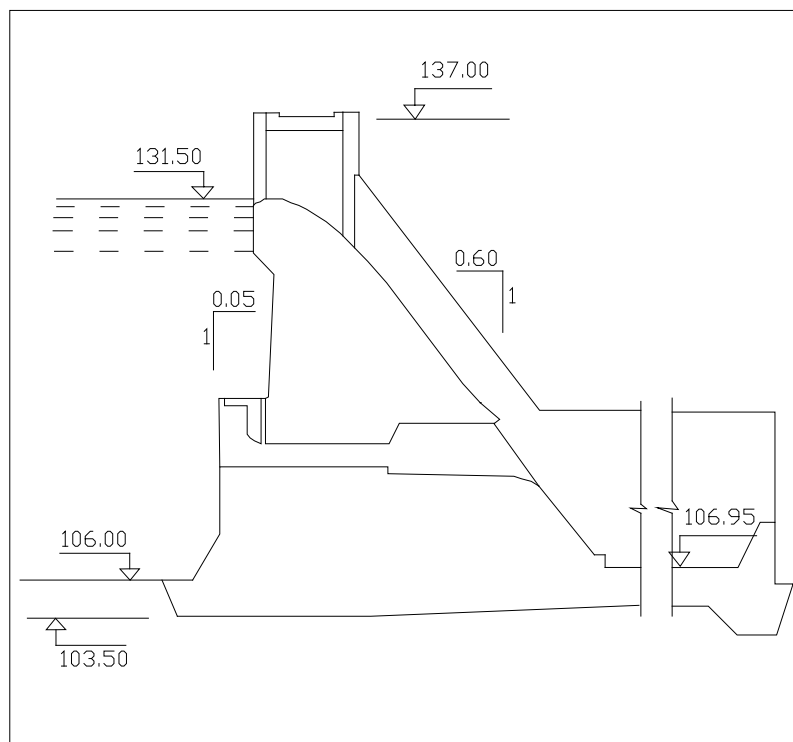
Sección transversal de la estructura de la presa José Bautista. Escala 1:500.
